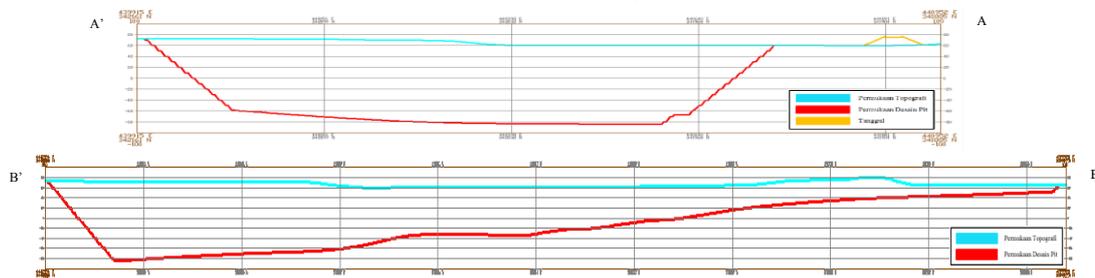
Section Kemajuan Tambang Tahun ke – 7
